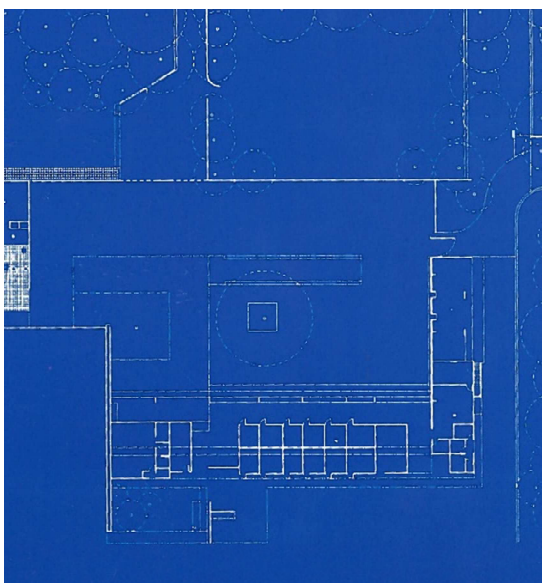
PLANTA DO ESPAÇO – IMAGEM – “BARRAGAN”- OBRA COMPLETA
